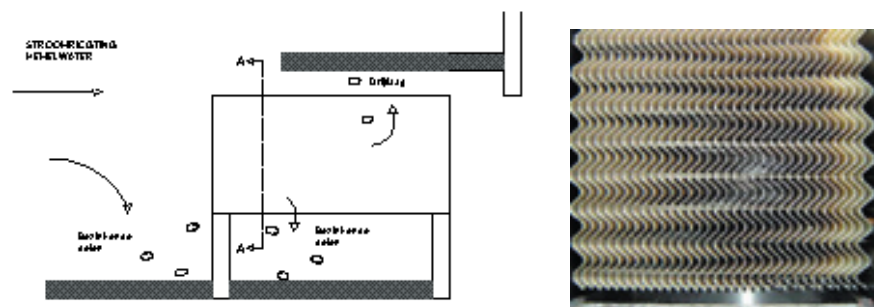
DETAIL ZIJAAZICHT HORIZONTAAL GEPLAATSTE LAMELLEN
